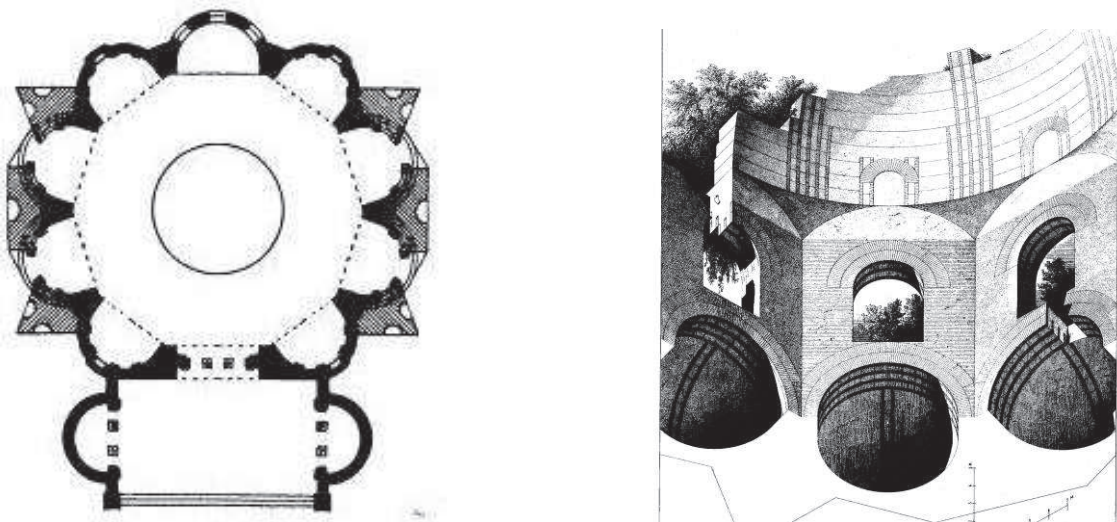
Minerva Médica. Planta y estructura de la bóveda. (Choisy)
